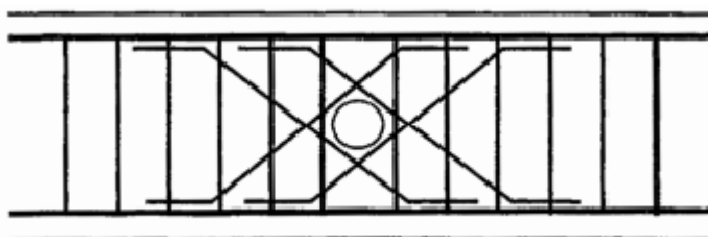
Armadura adicional na zona das aberturas segundo Mansur e Tan (1999)
